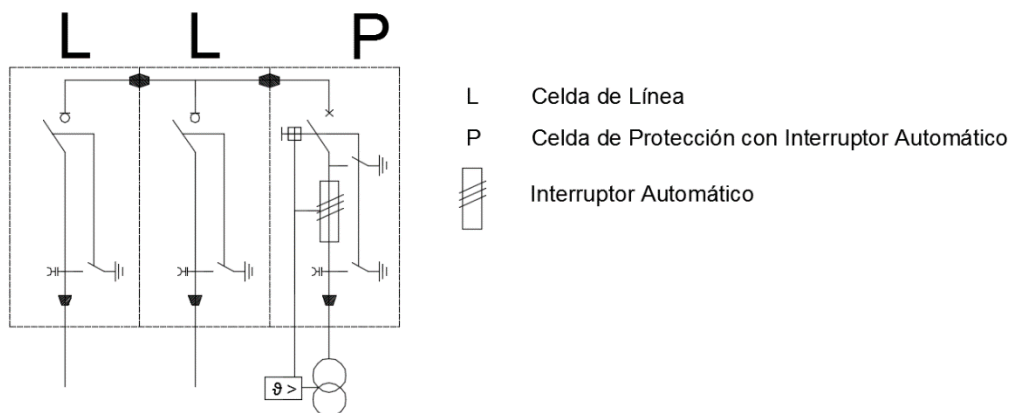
Doc. II. Cálculos - Protecciones Centro de Seccionamiento.
